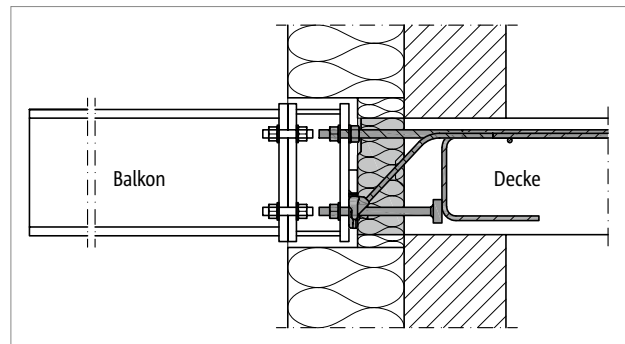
Schöck Isokorb® T Typ SKP: Anschluss des Stahlträgers an einen Adapter, der die Dicke der Aussendämmung ausgleicht
